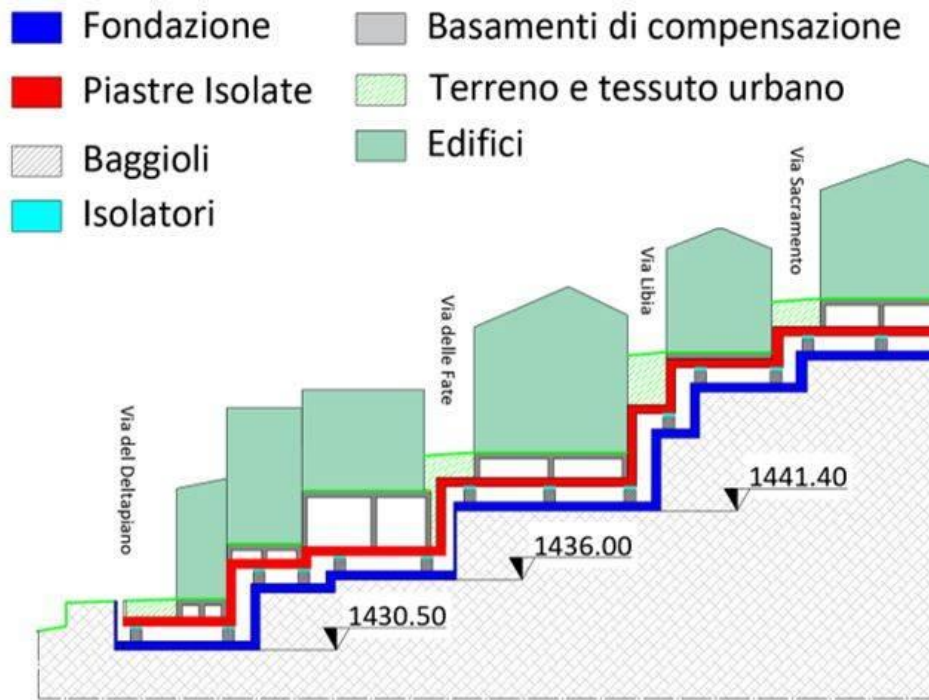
Schema dell'intervento in sezione (Mezzi, 2022)
